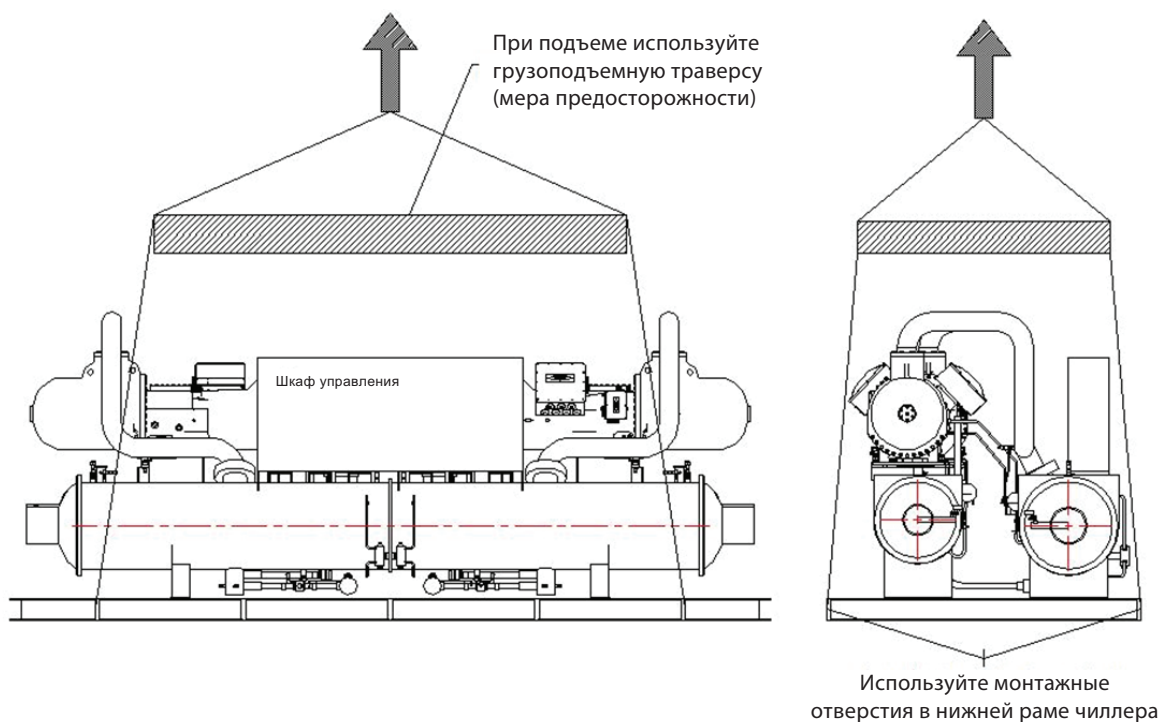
Схема подъема чиллера с двумя компрессорами
